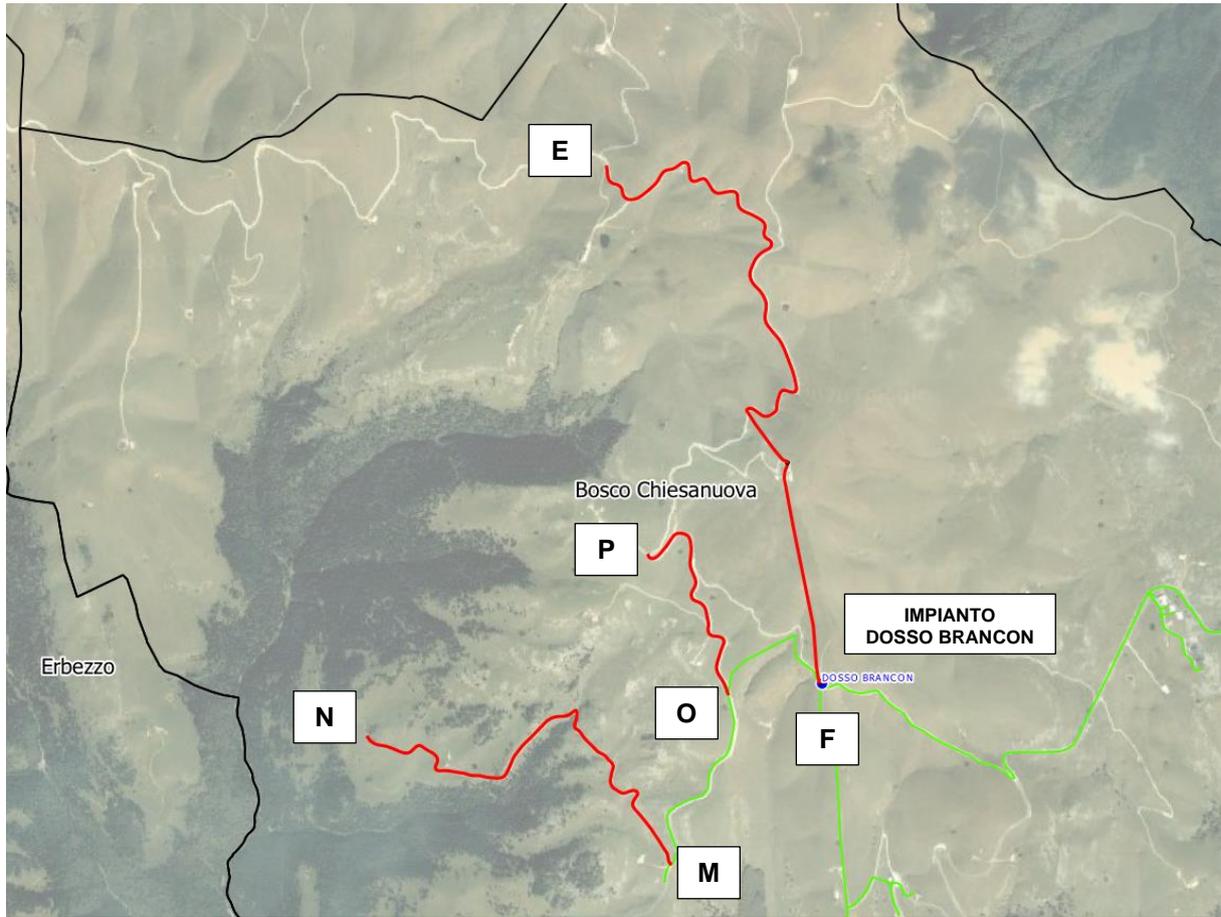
Planimetria generale dei tracciati EF, MN e OP. In rosso i tracciati di progetto, in verde la rete esistente.
